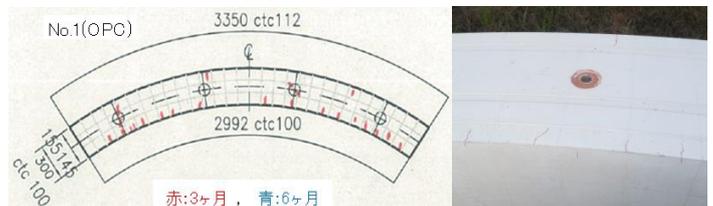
No. 1 試験体のひび割れ状況 (暴露後 6ヶ月)
